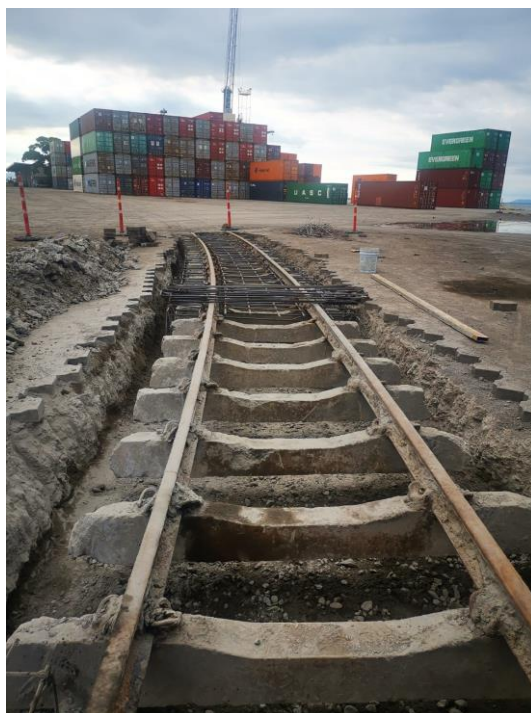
Trabajos de adecuación y armadura calle costado este patio 3
